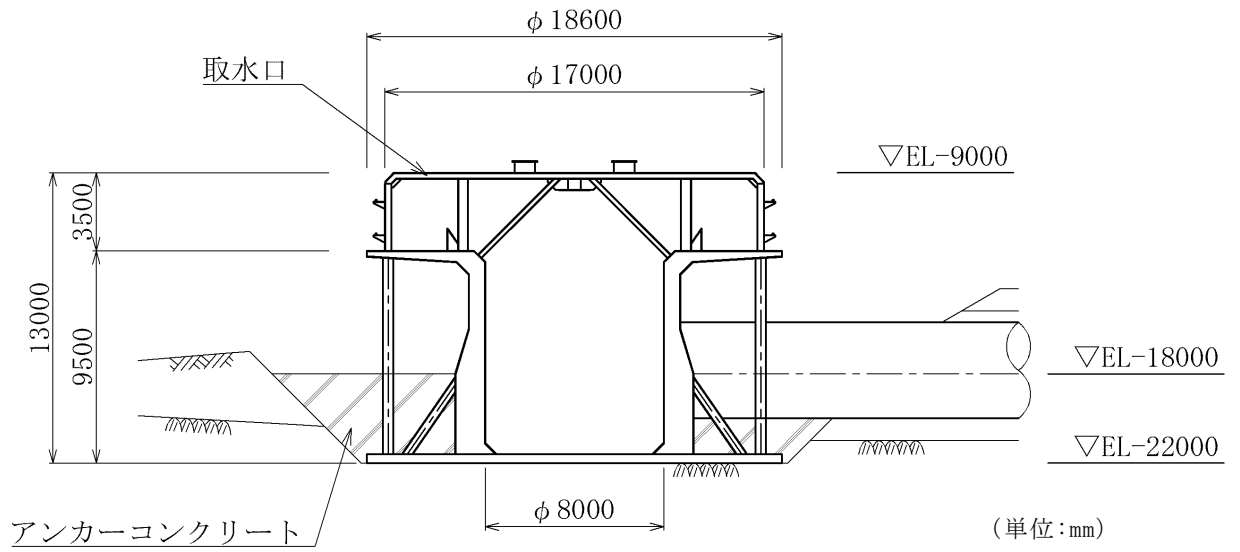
(1) 取水口 断面図 (A-A 断面)
